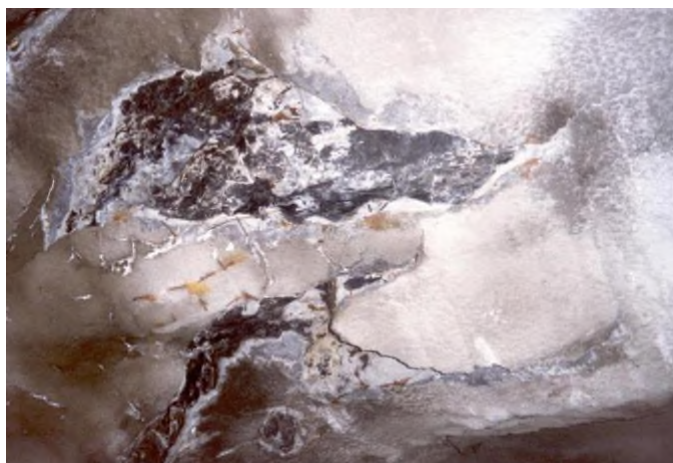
calcestruzzo spruzzato caduto da una sezione della calotta (combinazione di applicazione errata su un terreno umido e instabile di scisto sottoposto a congelamento prolungato)
